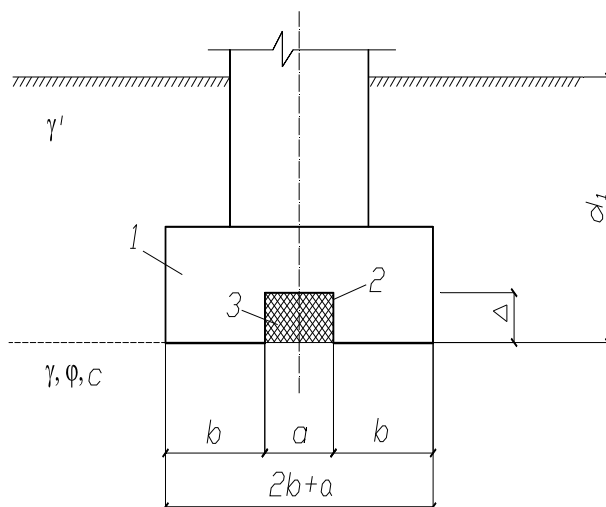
Стрічковий фундамент із поздовжнім вирізом по підшві
